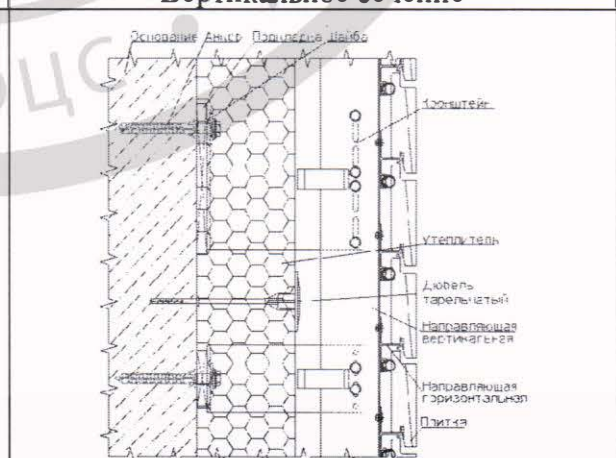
Облицовка - клинкерные и бетонные плитки. Вертикальное сечение
